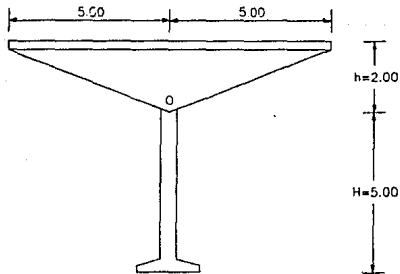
PARAGUAS DE CUBIERTA DE UNA NAVE INDUSTRIAL
